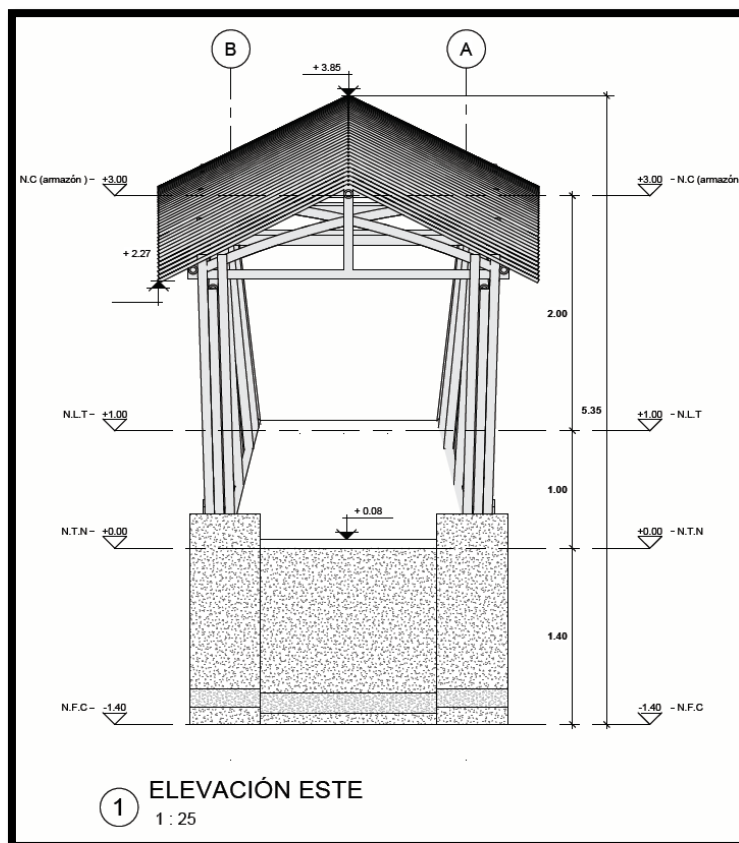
Plano Predimensionamiento - Vista Frontal
